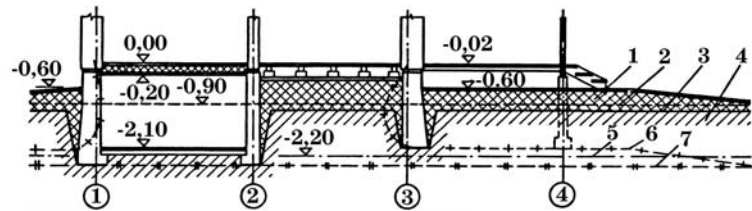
Поперечный разрез по подвалу и фундаментам при повышении планировочной отметки земли за счет насыпного грунта: 1 – насыпной грунт; 2 – уровень земли до подсыпки грунта; 3 – уровень грунта после снятия плодородного слоя; 4 – материковый грунт; 5 – уровень грунтовых вод в период промерзания грунта; 6 – расчетный уровень промерзания грунта (в период эксплуатации дома); 7 – нормативный уровень промерзания грунта (до начала строительства).
